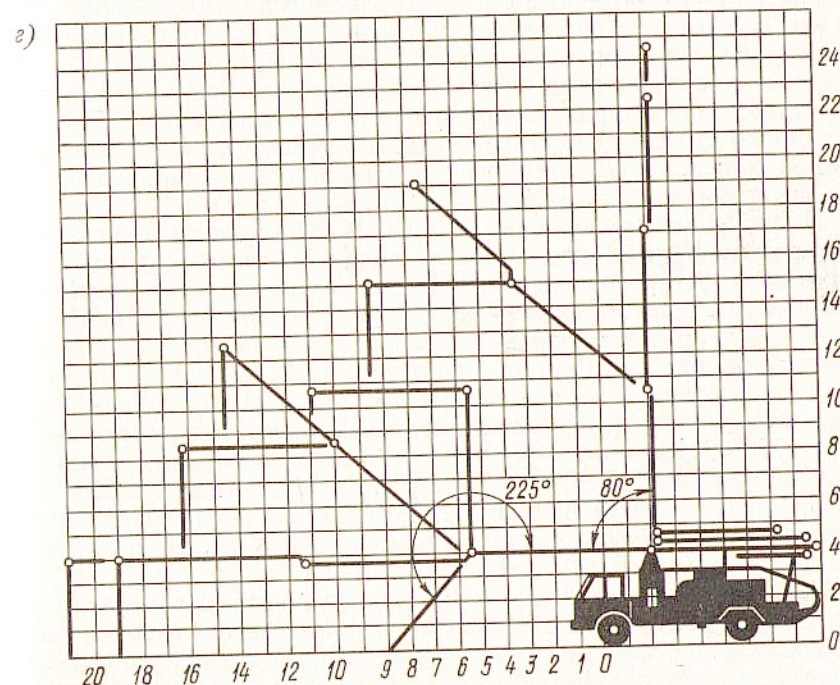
Трубопроводный транспорт для перемещения бетонной смеси
